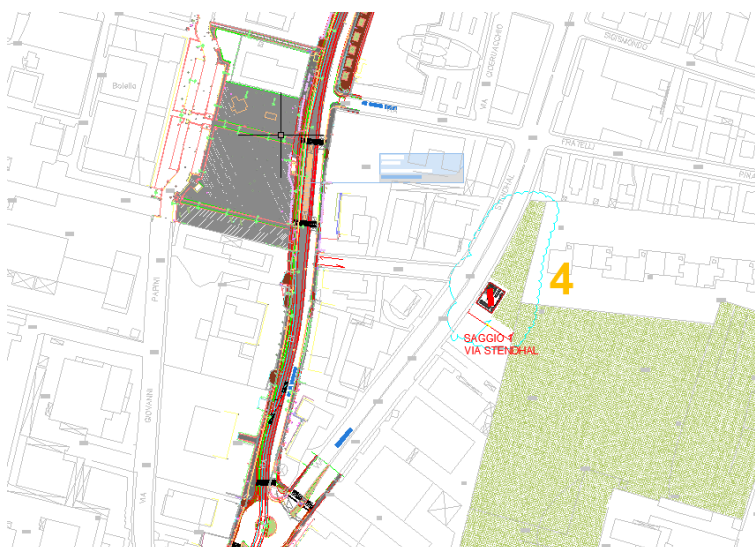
dettaglio planimetrico con la localizzazione dei sondaggi
